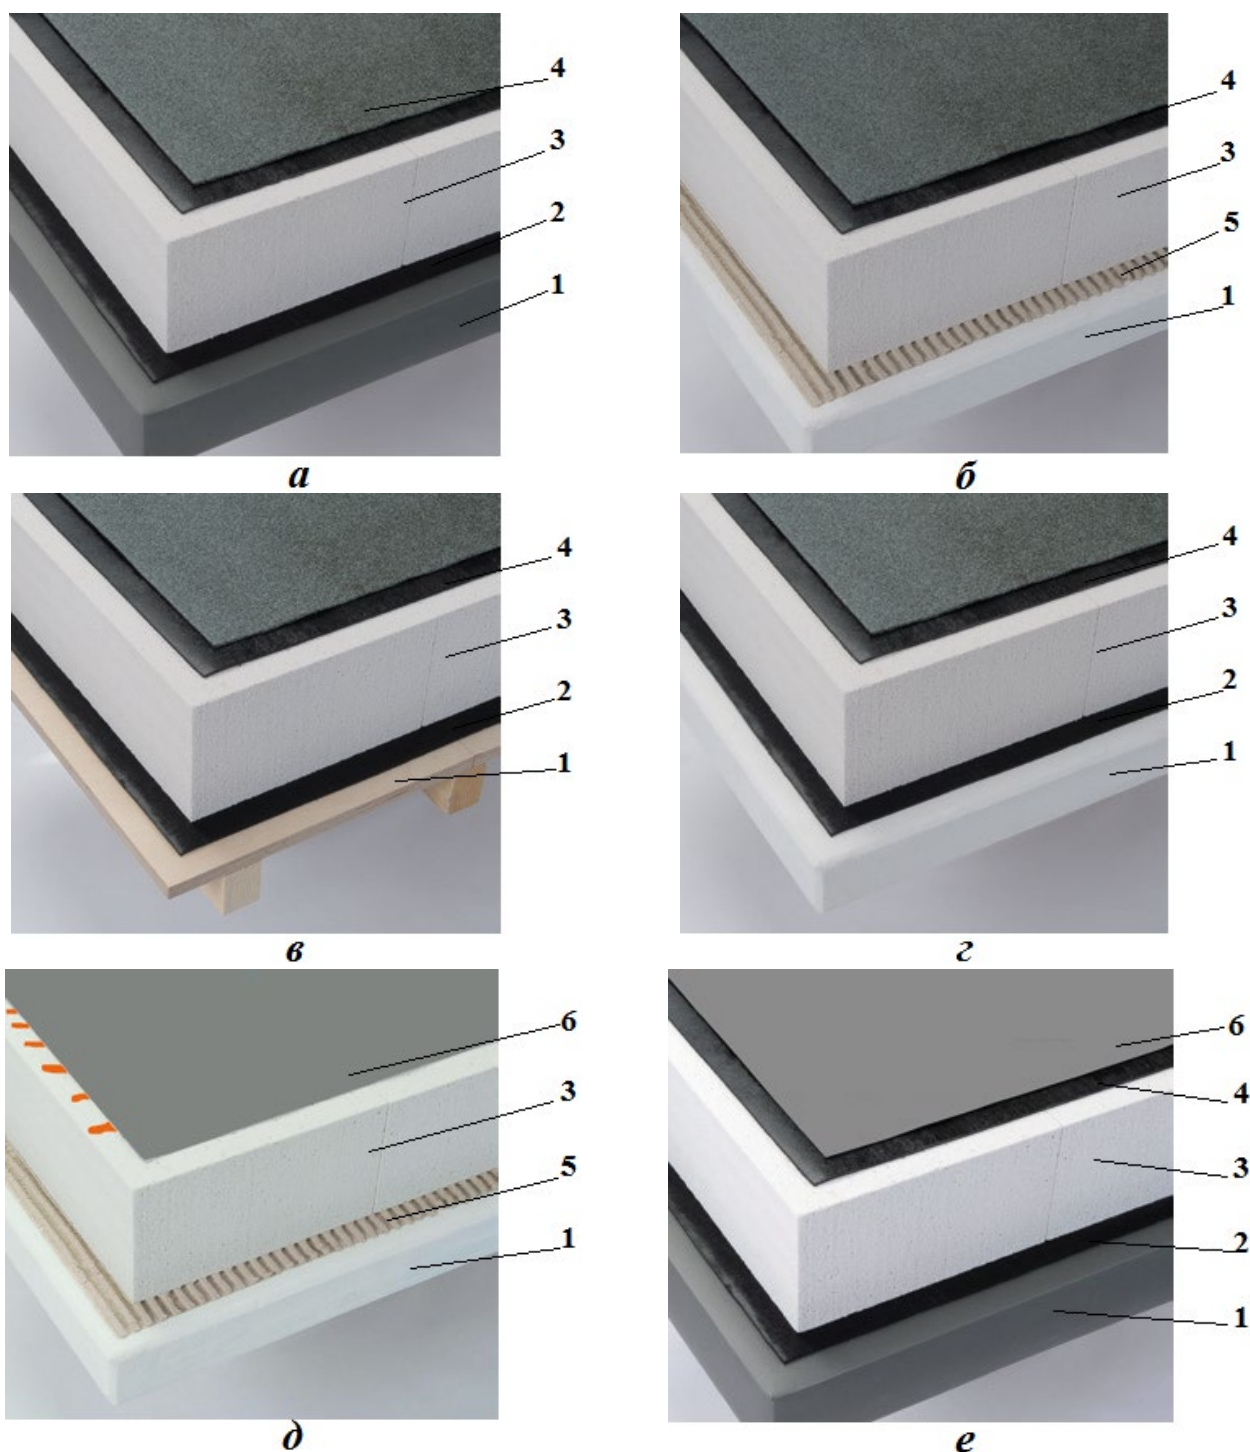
Клеевая кровельная система: а, е — по железобетонному перекрытию; б, г, д — по газобетонной плите; в — по деревянному основанию; 1 — основание; 2 — пароизоляция (битумная с грунтовкой); 3 — минеральная изоляционная плита; 4 — многослойный полимербитумный рулонный материал приваренный; 5 — легкий раствор; 6 — полимерная кровельная мембрана, монтируемая на клей
